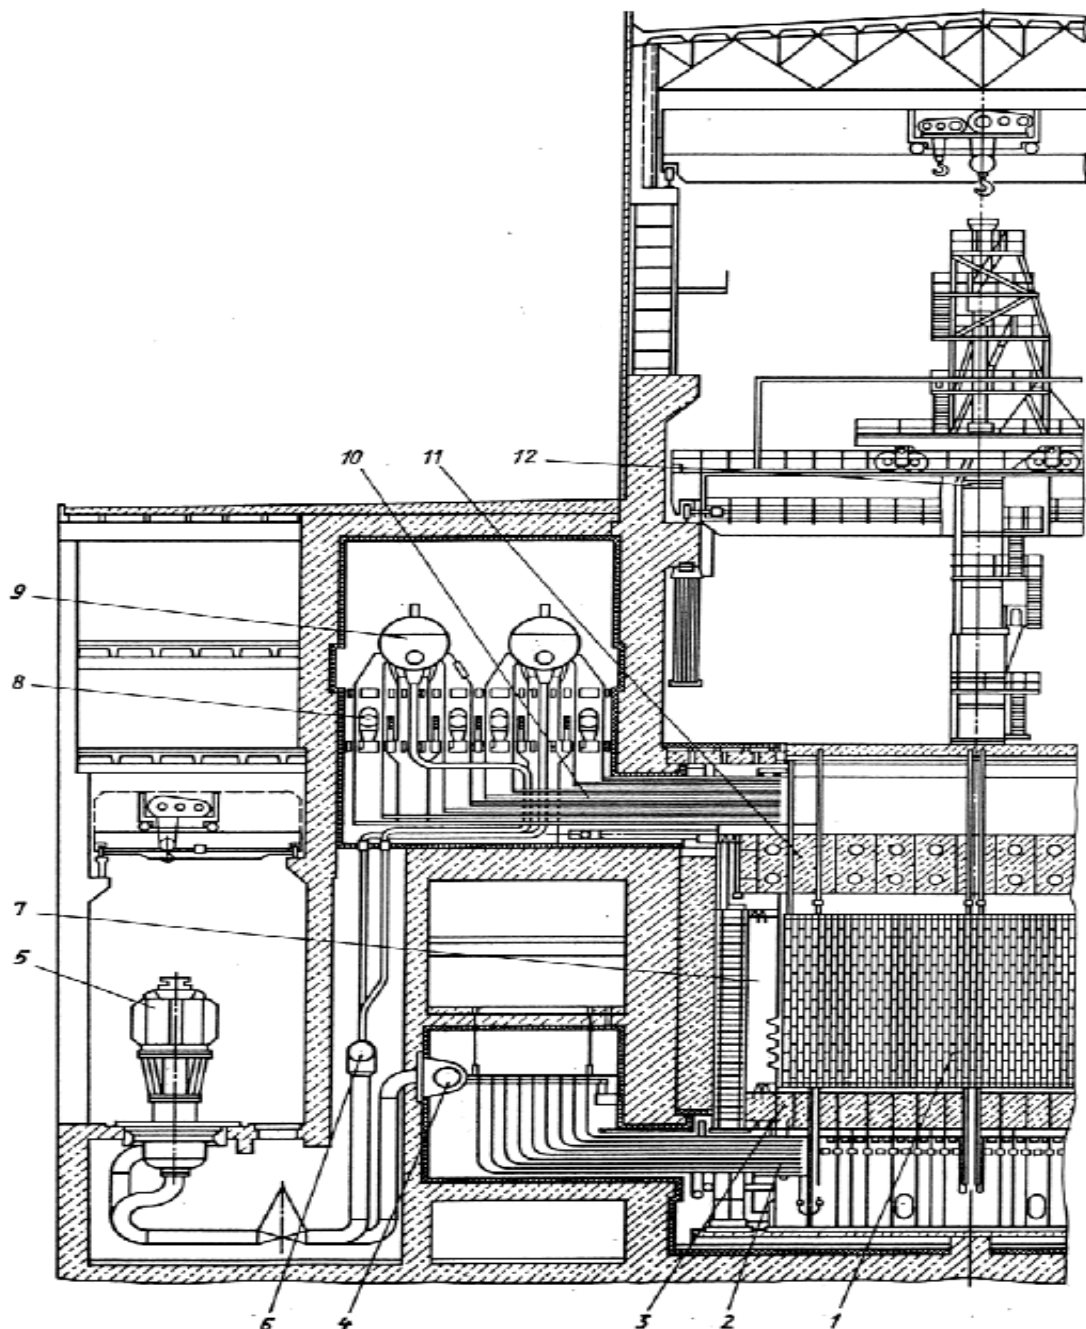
2 - Загальний вигляд реактора РБМК – 1000:
